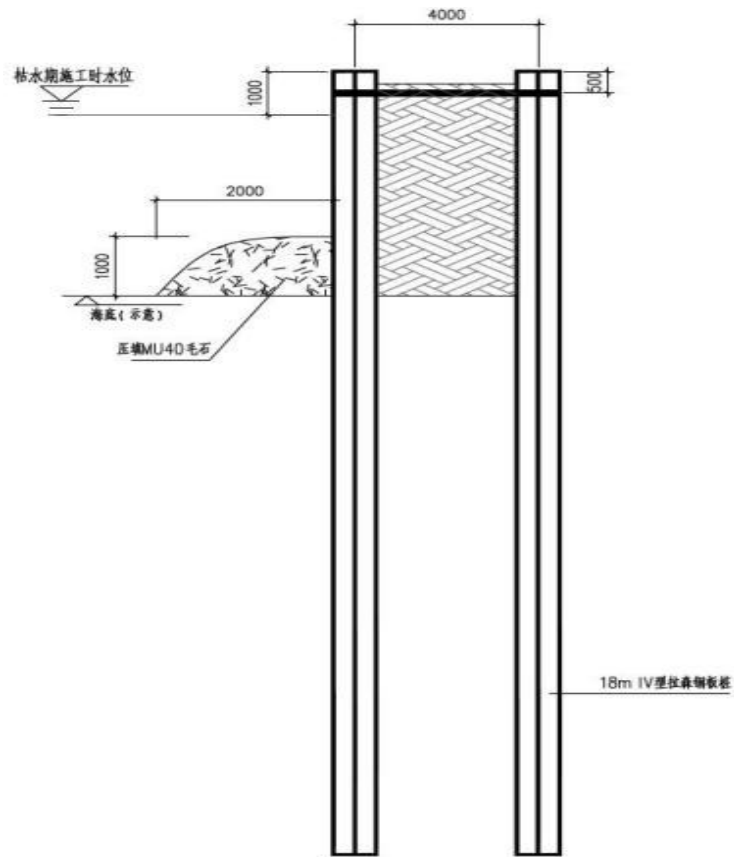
海边顶管接收井（节点 WS-212）围堰剖面图
